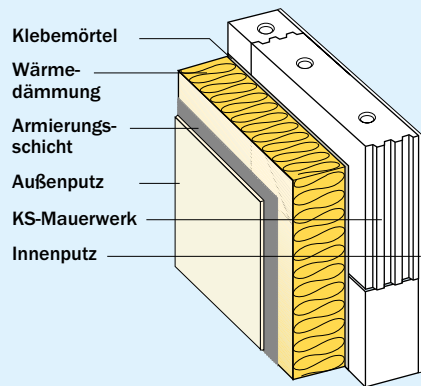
KS-Mauerwerk ist ein idealer Untergrund für jedes Wärmedämm-Verbundsystem.
